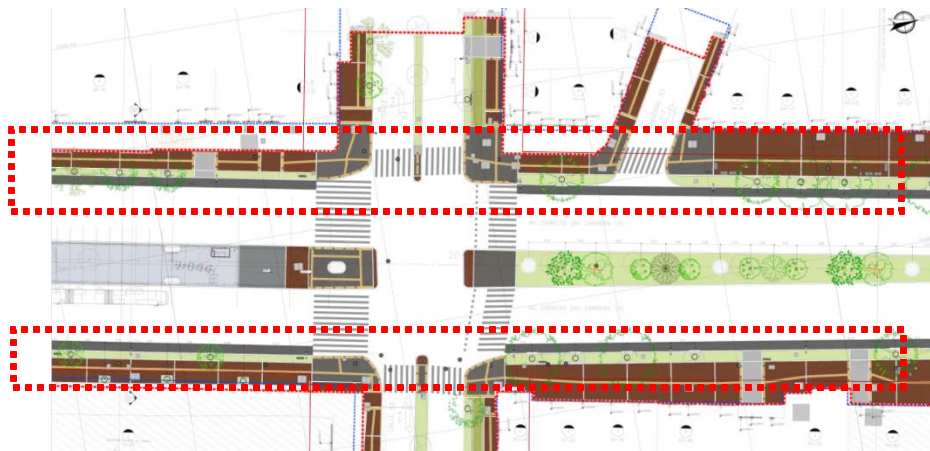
Planta tipología arbolado del paisaje lineal estructurante.
